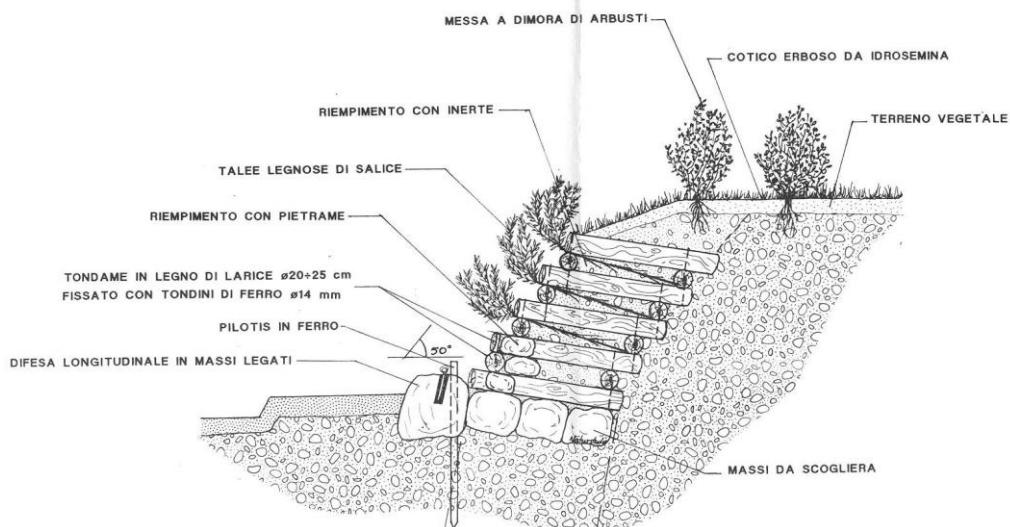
Palificata viva spondale a doppia parete - sezione.
